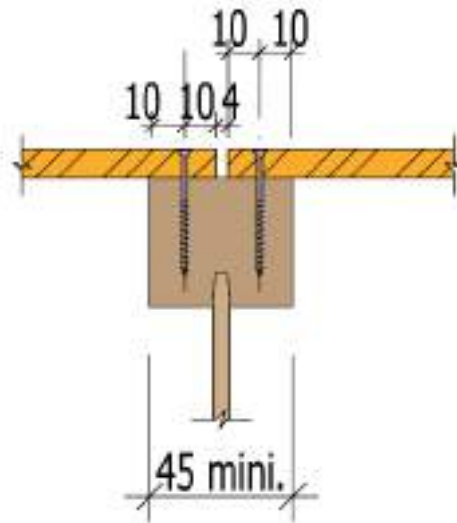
Fixation de deux panneaux adjacents de contreventement sur membrure de montant poutre en I
